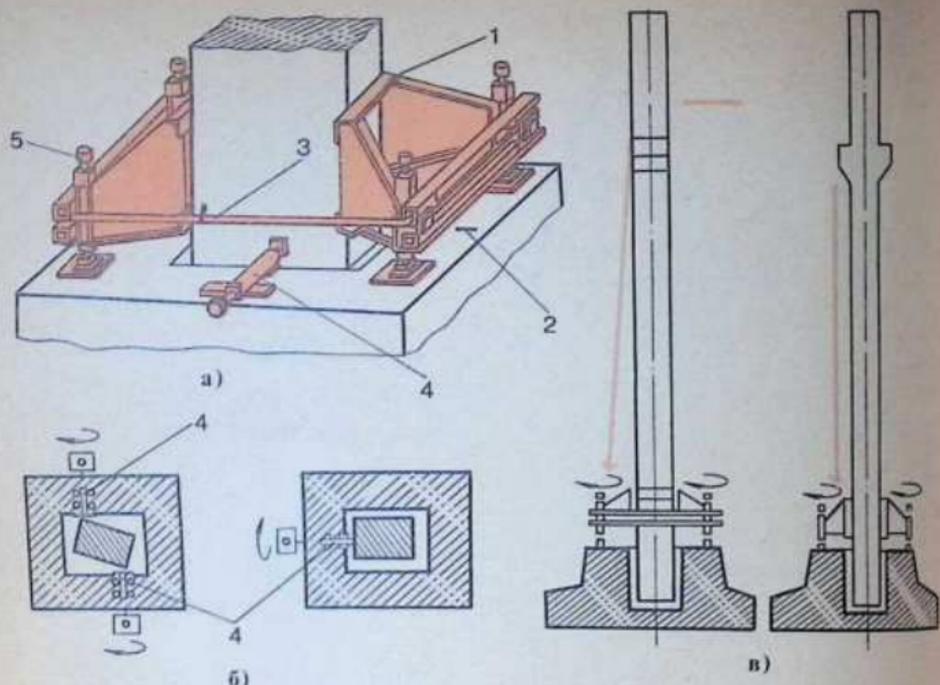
Кондукторы для закрепления колонны массой до 5 т в стакане фундамента: а — общий вид, б — схема рихтовки колонны в плане, в — схема вертикальной рихтовки колонны; 1 — ферочки кондуктора, 2 — риски, 3 — стяжной болт, 4 — горизонтальный переставной дократ, 5 — винтовые дократы кондуктора
